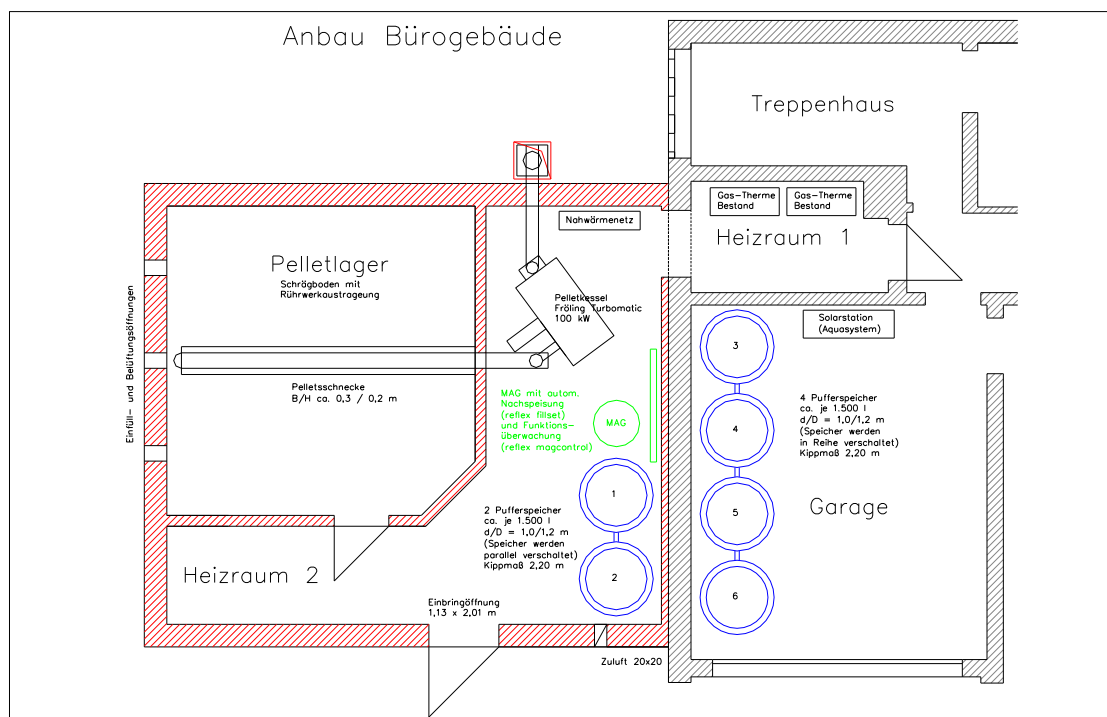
Ausschnitt Grundriss Kellergeschoss Verwaltungsgebäude Wiershäuser Weg 27, Hannover versch Münden
